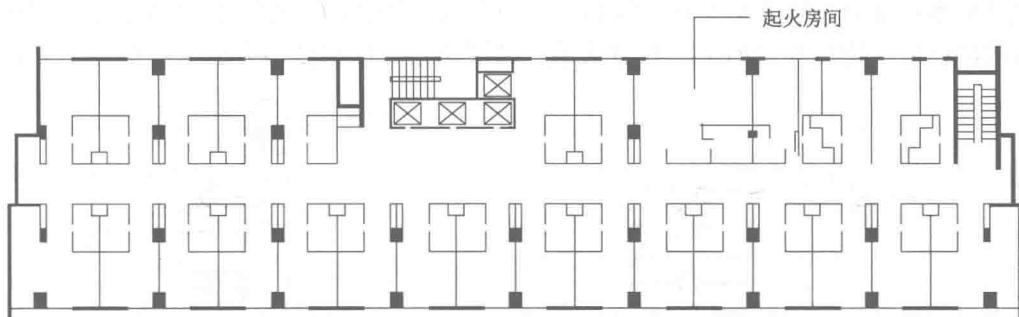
哈尔滨天鹅饭店标准层平面图及起火房间位置
